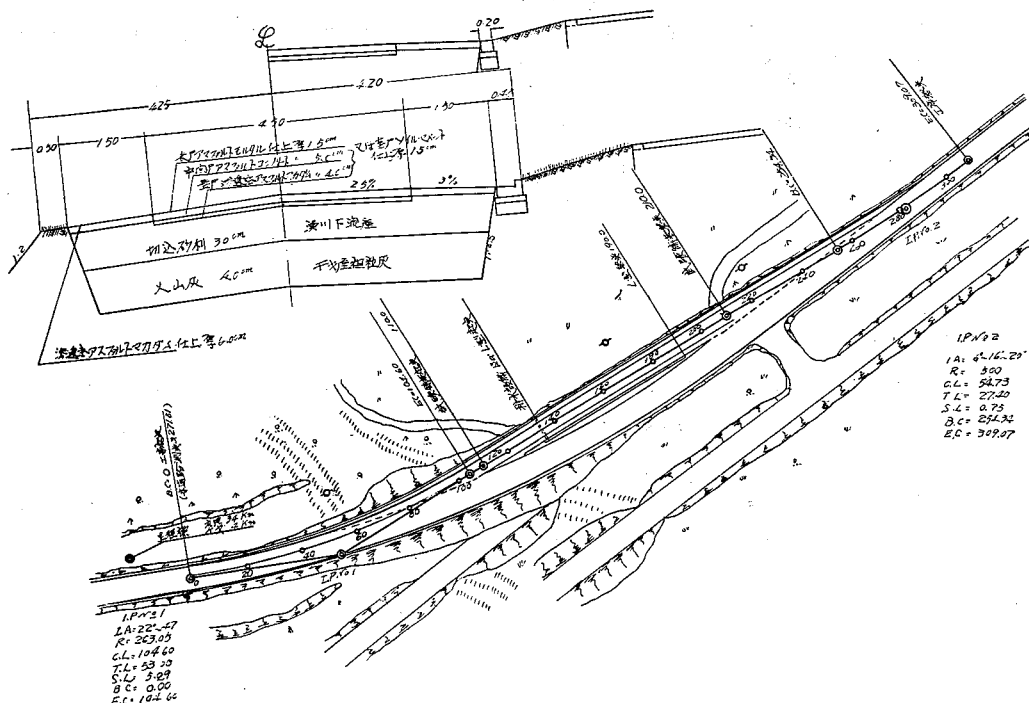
試験道路平面図、標準横断面図 1級国道36号線千歳市上長都地内
